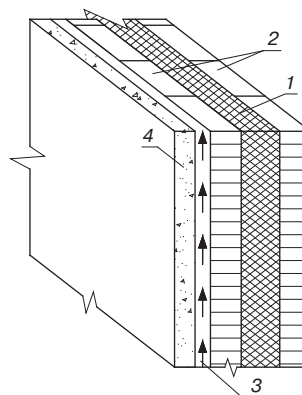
Конструктивное решение вентилируемой наружной стены с декоративным железобетонным экраном: 1 – утеплитель; 2 – мелкогабаритные блоки (ячеистый бетон или кирпич); 3 – воздушная прослойка; 4 – железобетонный экран
